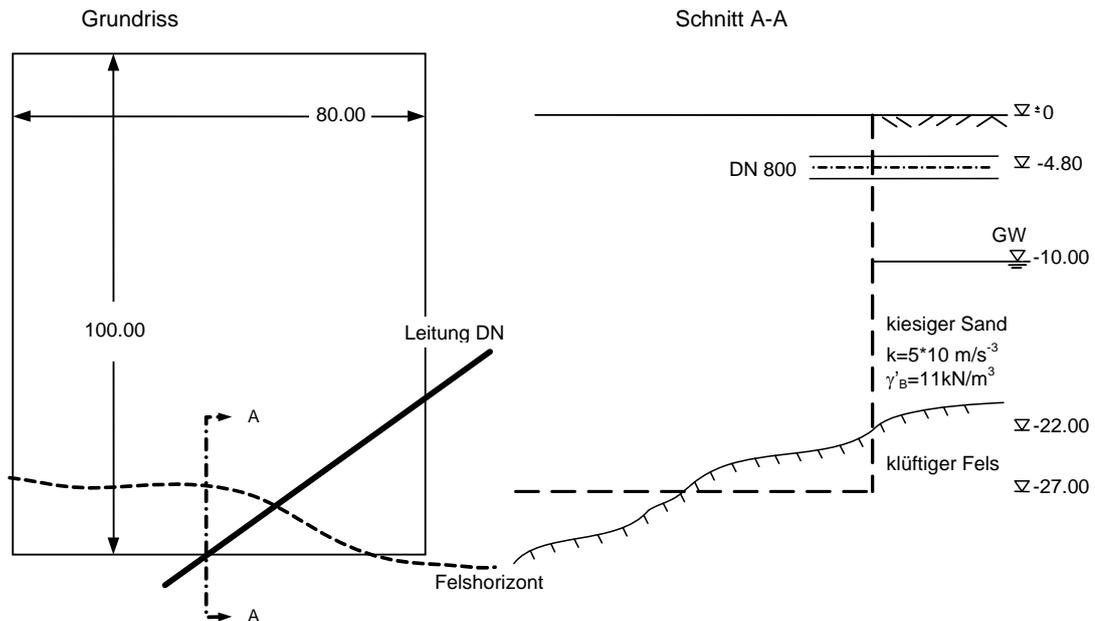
Grundriss und Schnitt der Baugrube
